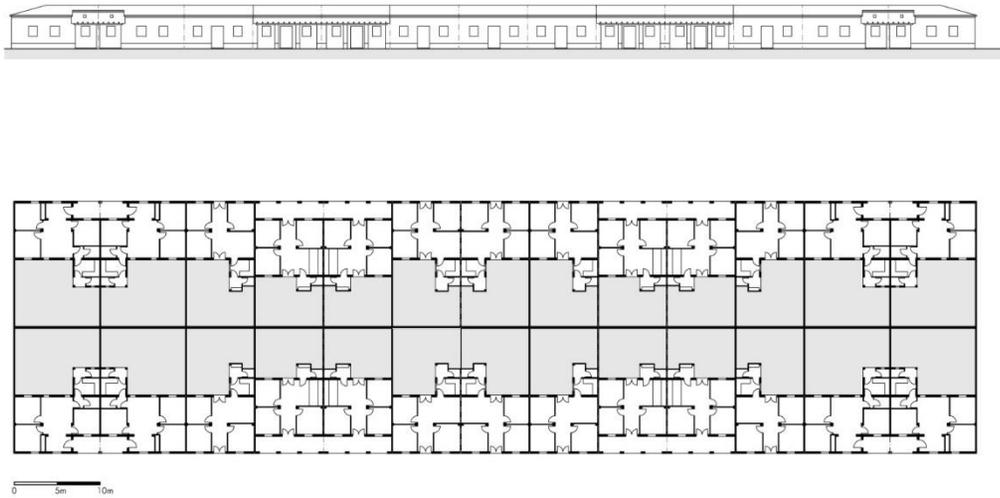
Alzado y planta de Viviendas para Jornalero en Nules
